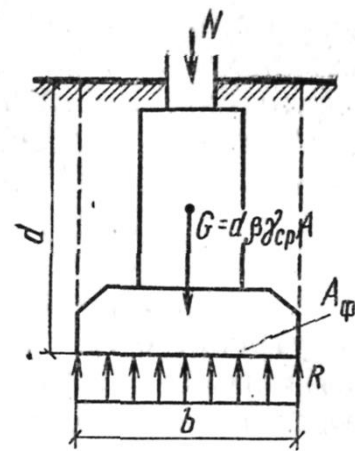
Приклад розрахункової схеми центрально навантаженого фундаменту
